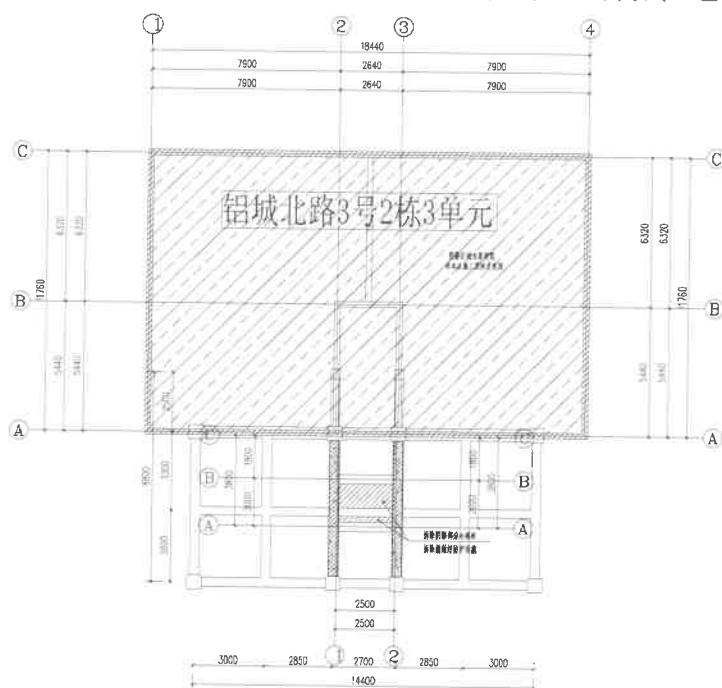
车库顶板剔除范围平面布置图（委托方提供）
